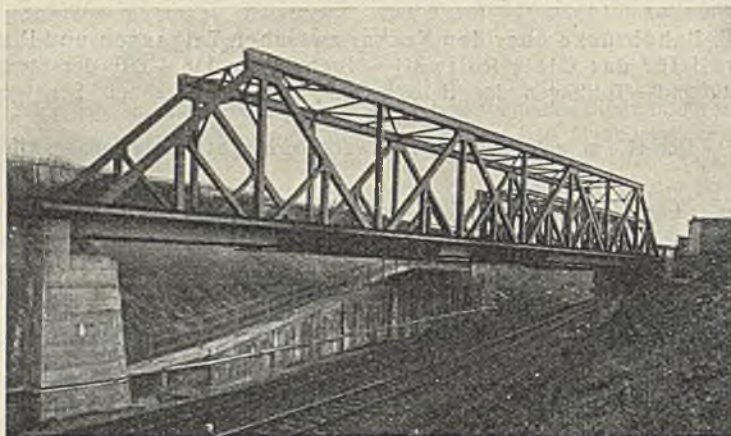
Einleisige Eisenbahnbrücke beim Bahnhof Zentral-Viehhof in Berlin.
